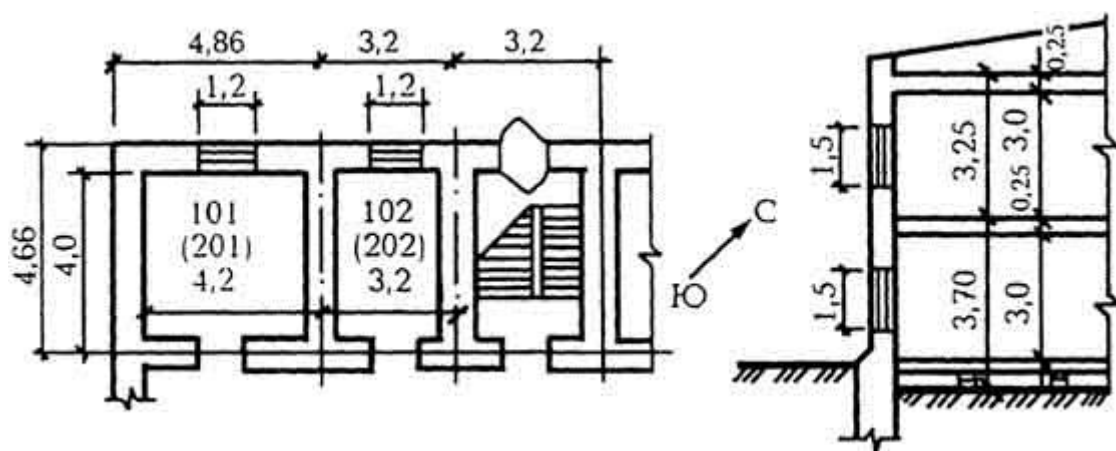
План и разрез помещений здания общежития (к примерам 2.1, 2.2 и 2.3)
